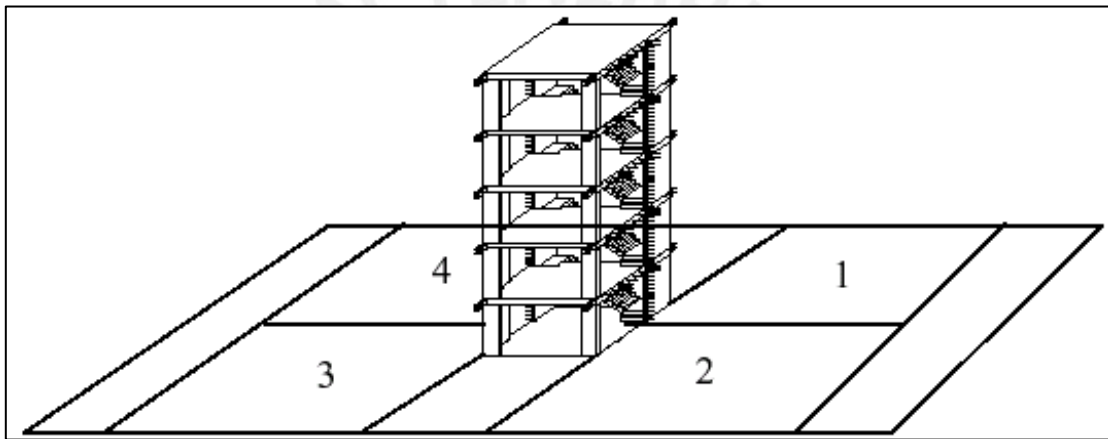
Caja de escaleras aislada de la estructura del edificio (Orihuela, 2003)
